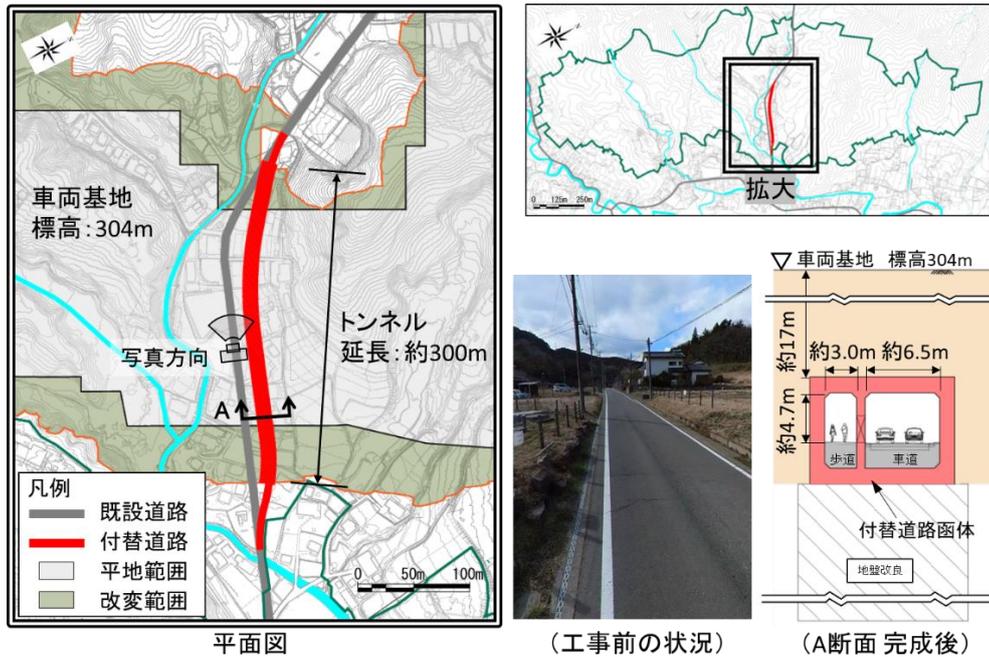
付替道路工（県道 64 号）の施工概要
